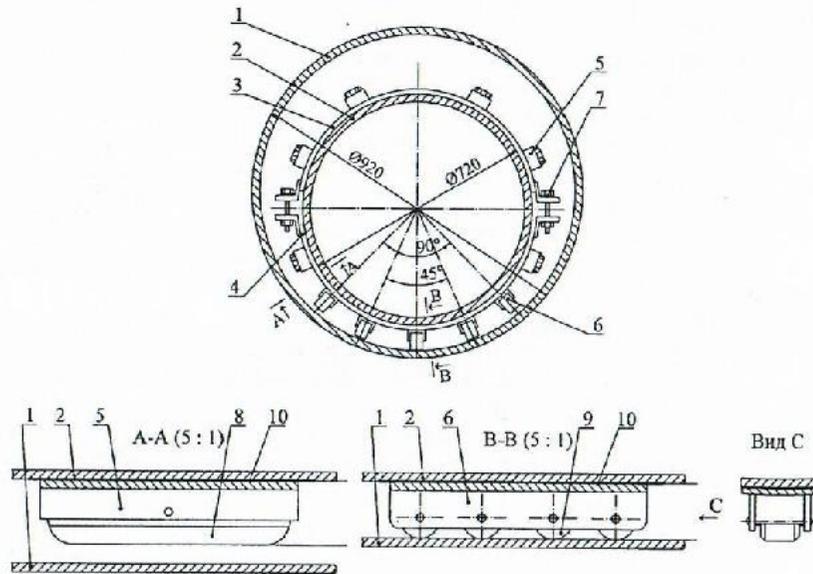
Опорно-направляющее кольцо с опорами скольжения и опорами качения Тип II (комбинированное), для протаскивания магистрального трубопровода в кожухе (футляре) под автомобильными и железными дорогами длина протаскивания более  $l=1500$  м
